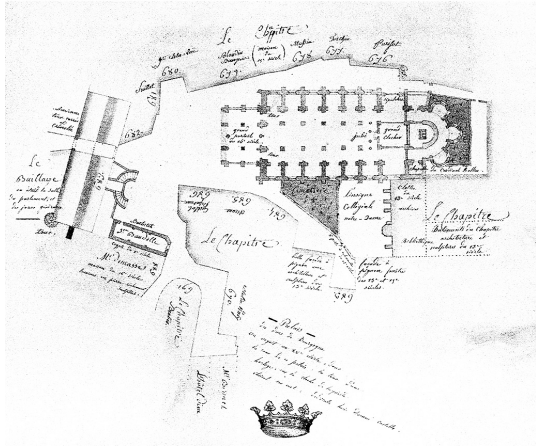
ポーヌ、聖母聖堂（18世紀の平面図）
